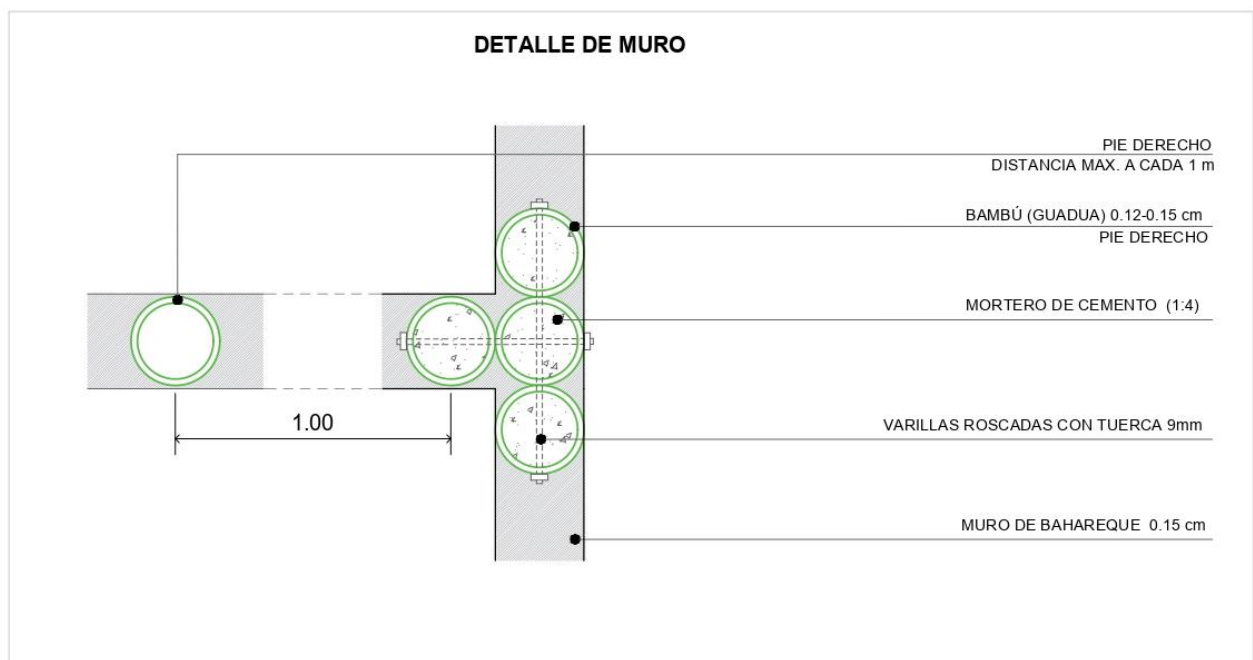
Detalle constructivo de muro estructural, vista en planta. Fuente: El autor
